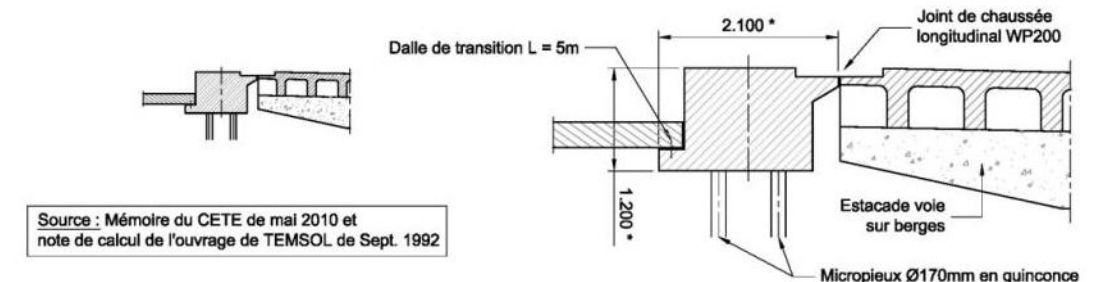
Coupe transversale estacade voie sur berge, secteur amont rive gauche
